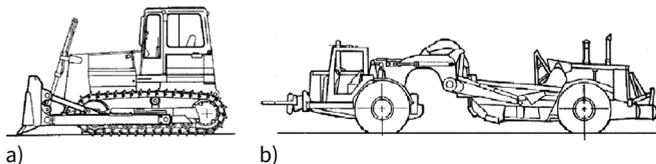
Beispiel für a) eine Planierraupe und b) einen Doppelmotor-Scraper mit Push-Pull-Einrichtung (adaptiert nach [34])
